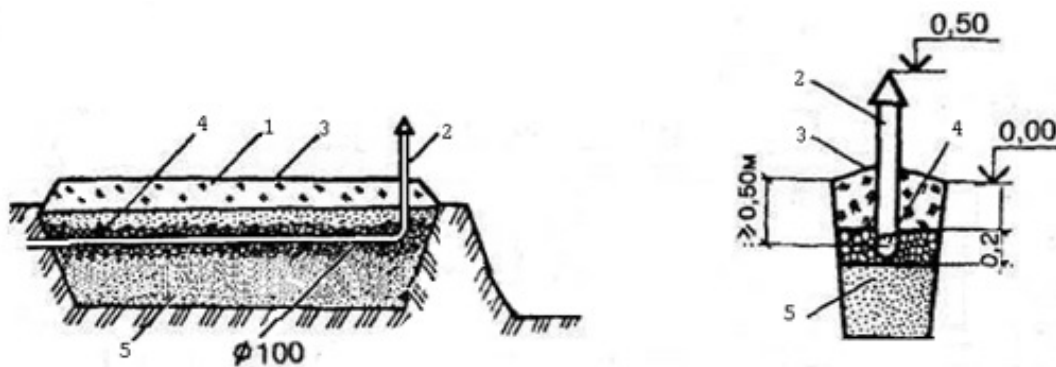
Поля поглощения: 1 – насыпной грунт 2 - стояки вентиляции 3- рулонная гидроизоляция 4-оросительная система 5- впитывающий грунт
